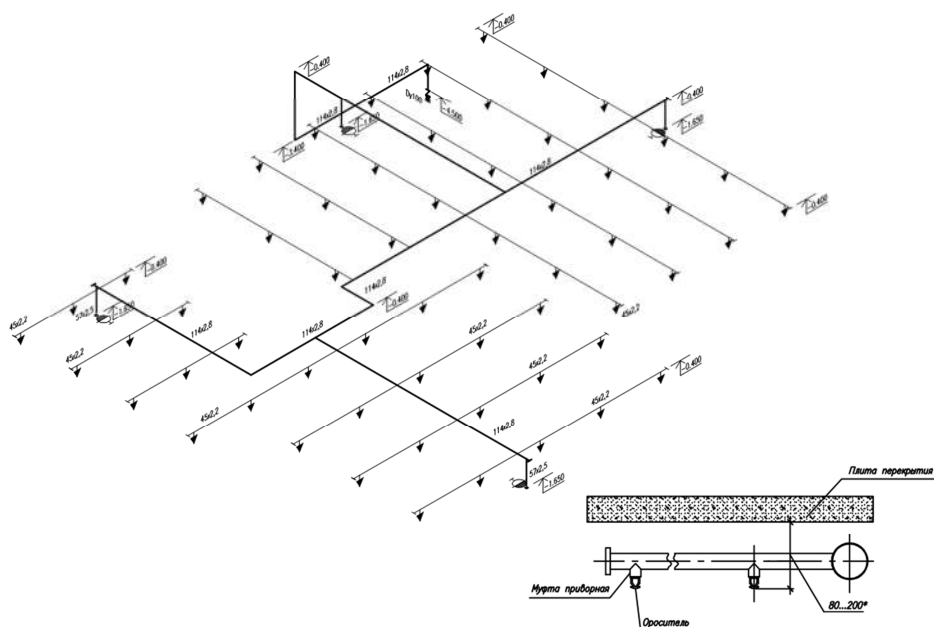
Отметки высот трубопроводов, пожарных кранов и узла управления. Допустимое расстояние от распылителей до перекрытия.
